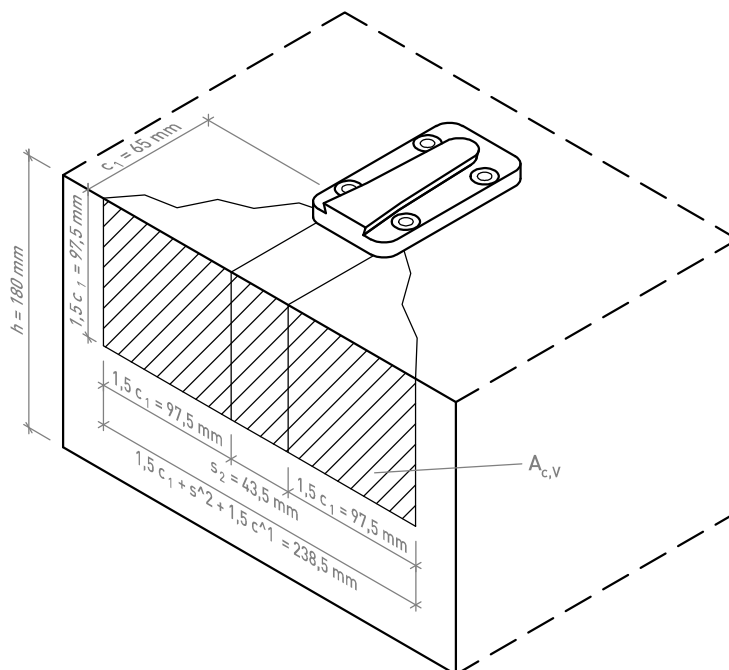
Ausbruchkörper bei Betonkantenbruch
